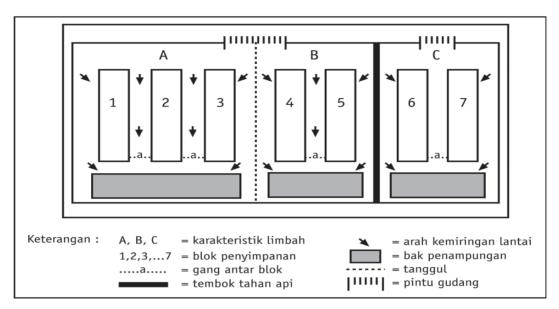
Contoh rancang bangun fasilitas Penyimpanan Limbah B3 dengan sirkulasi udara dalam ruang bangunan Penyimpanan Limbah B3
